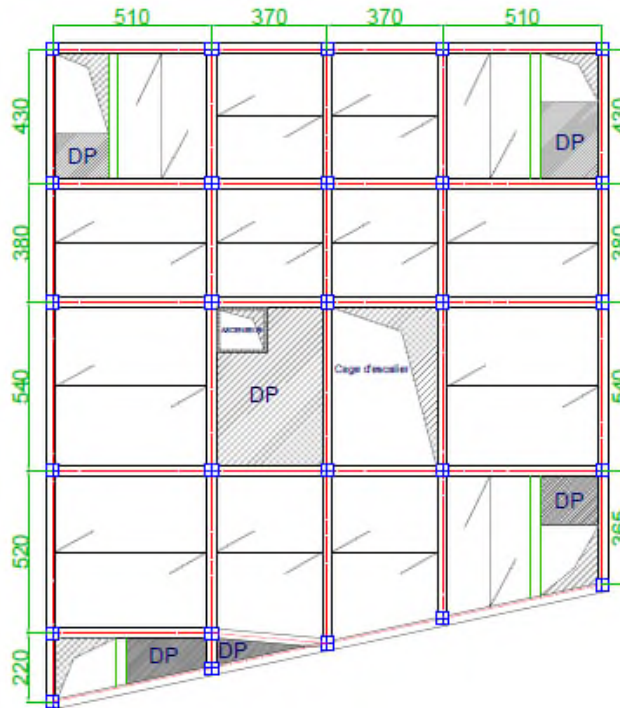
Disposition des poutrelles au niveau de l'étage 1 à 8.
